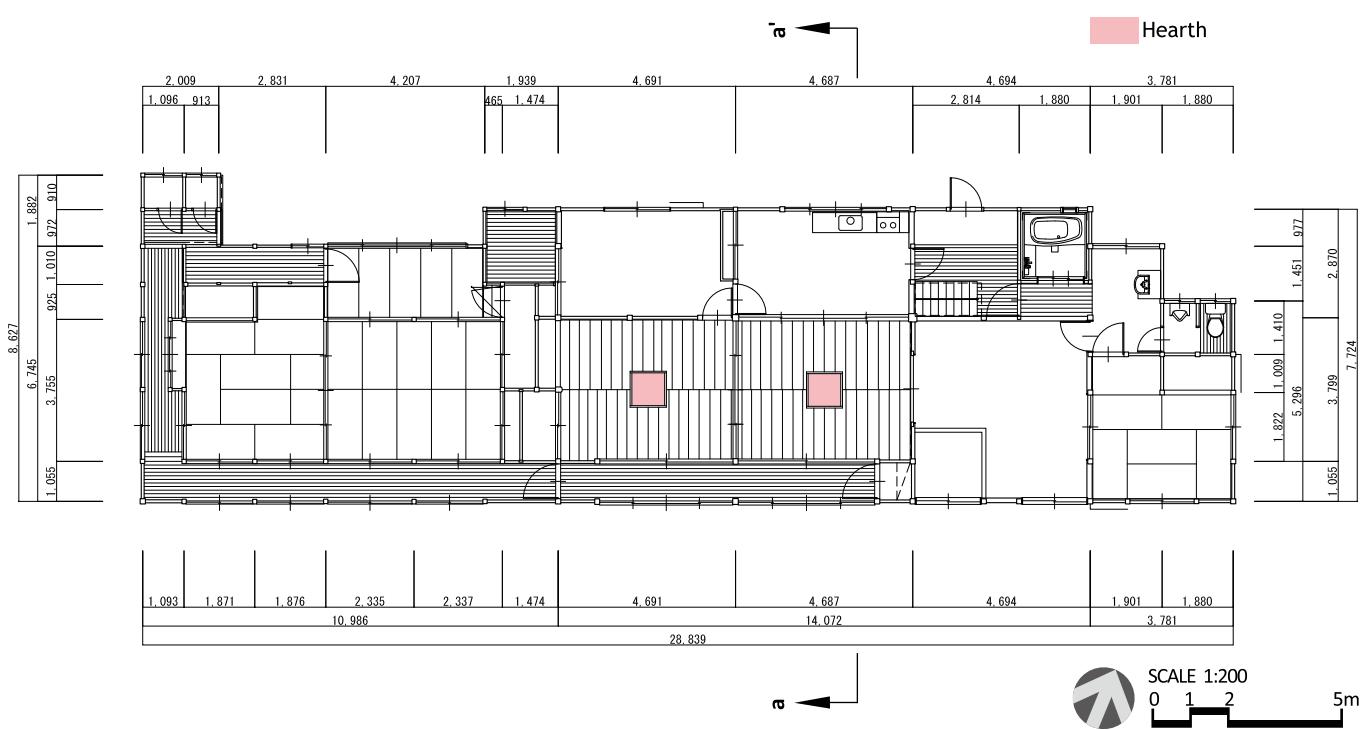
S3 高山社跡 主屋兼蚕室一階平面図
